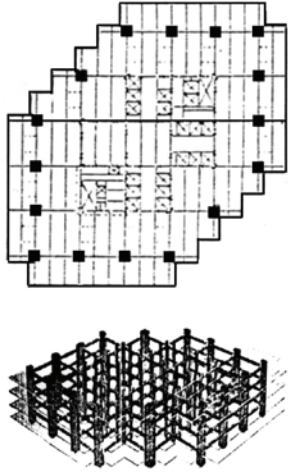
b y _c: Planta tipo de la torre y esquema tridimensional de su estructura.
